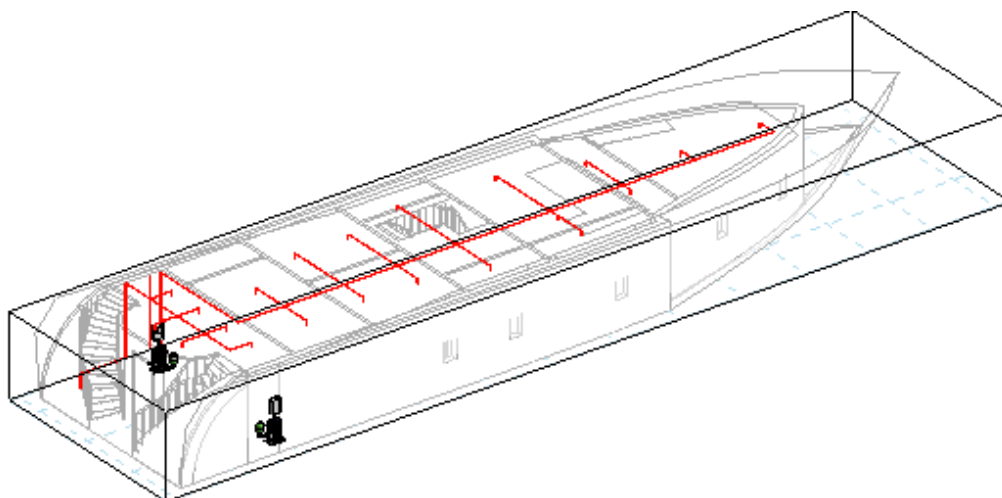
Detalle de la distribución de los rociadores en la cubierta inferior.
